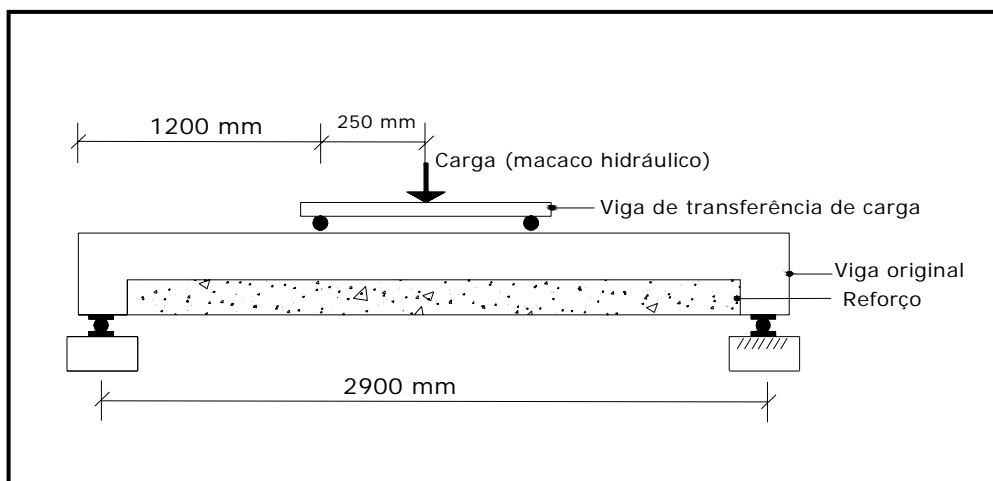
Esquema de carregamento das vigas de PIANCASTELI e CALIXTO (2002).
